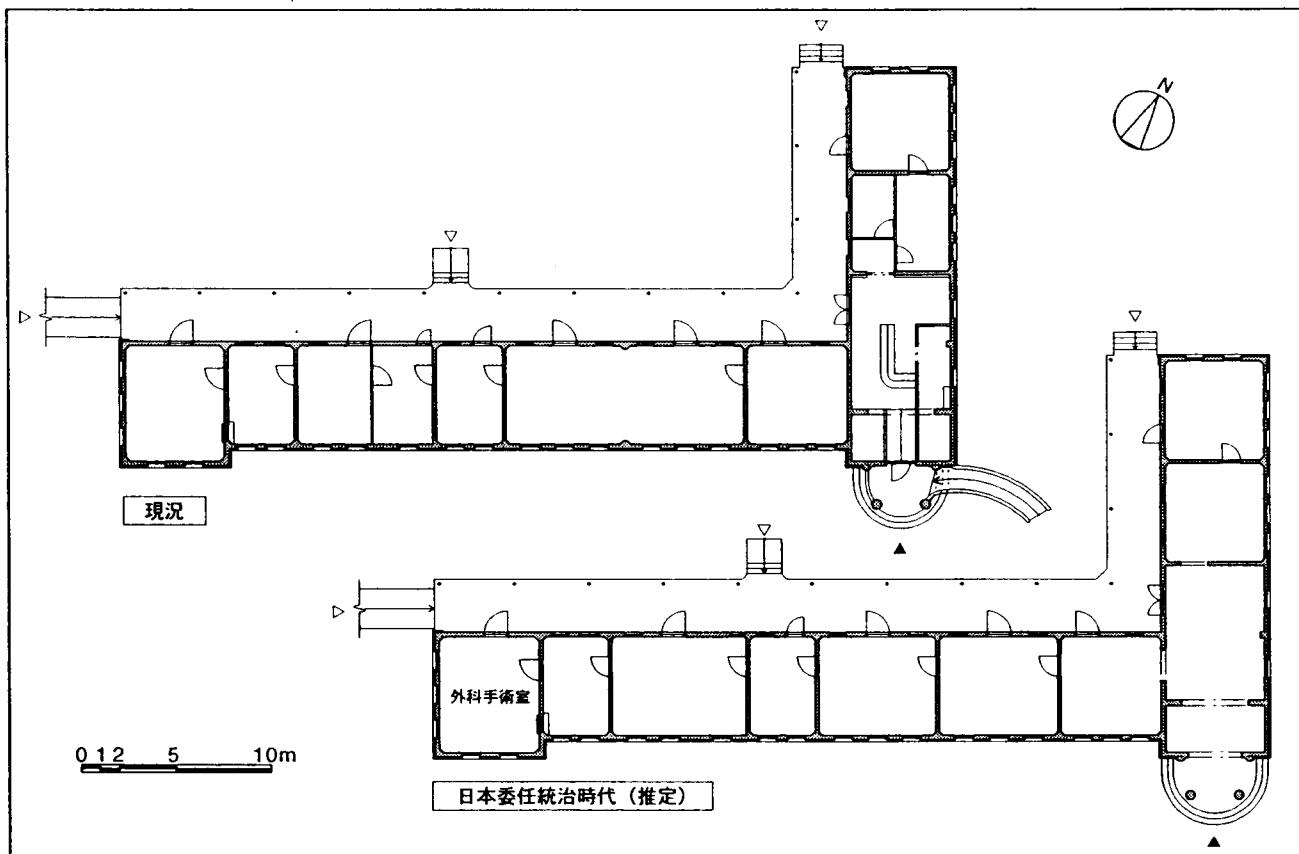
旧パラオ医院本館（現パラオコミュニティーカレッジ・メインオフィス）の現況平面図と推定平面図
